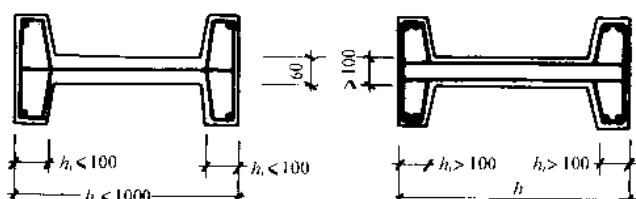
钢筋混凝土墙托梁与防风梁	图页	1—148
